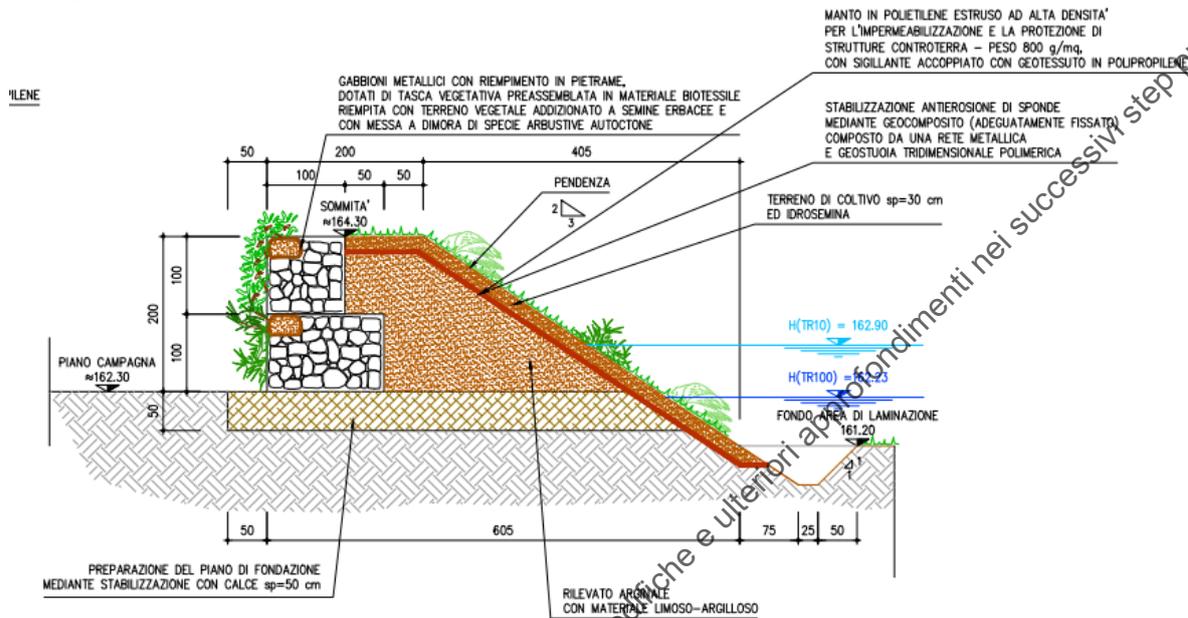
sezione tipo 6, area di laminazione B. Estratto da Tav. 10
